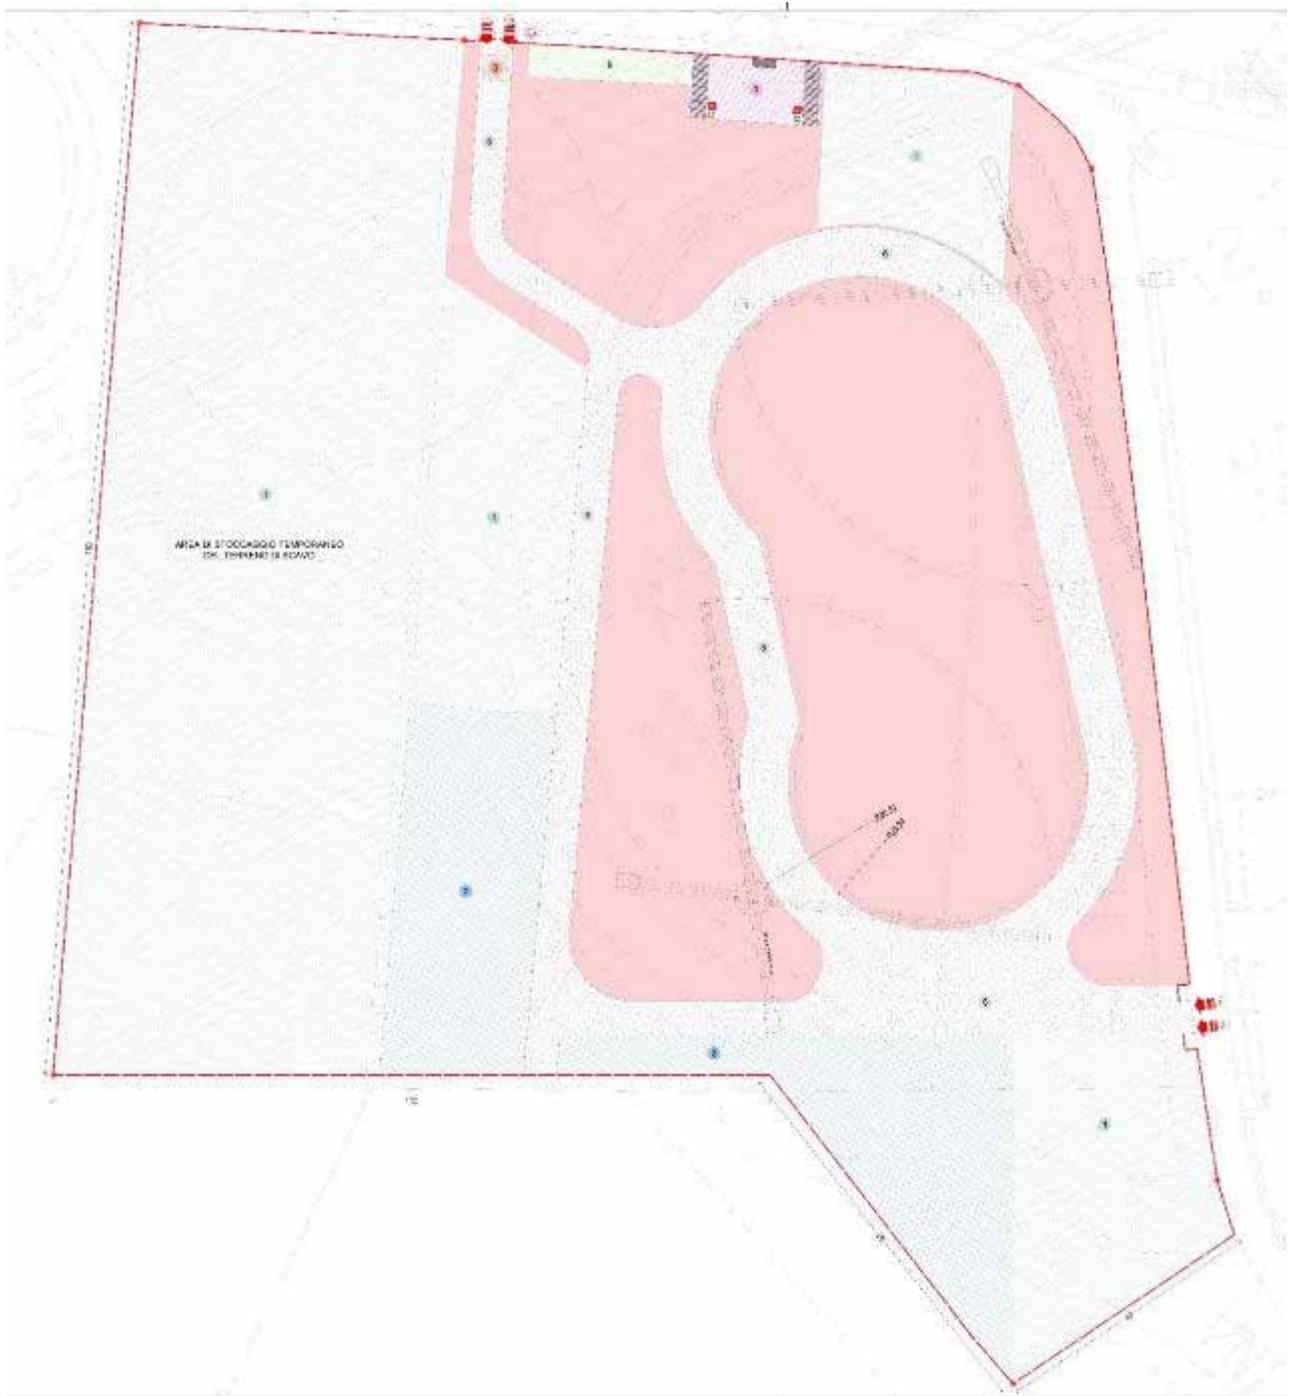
Esstratto della planimetria generale del cantiere relativo al serbatoio di Montagnana.
